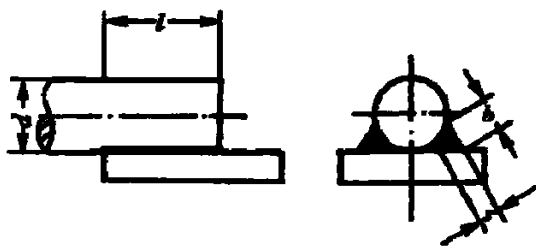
钢筋与钢板搭接焊接头
